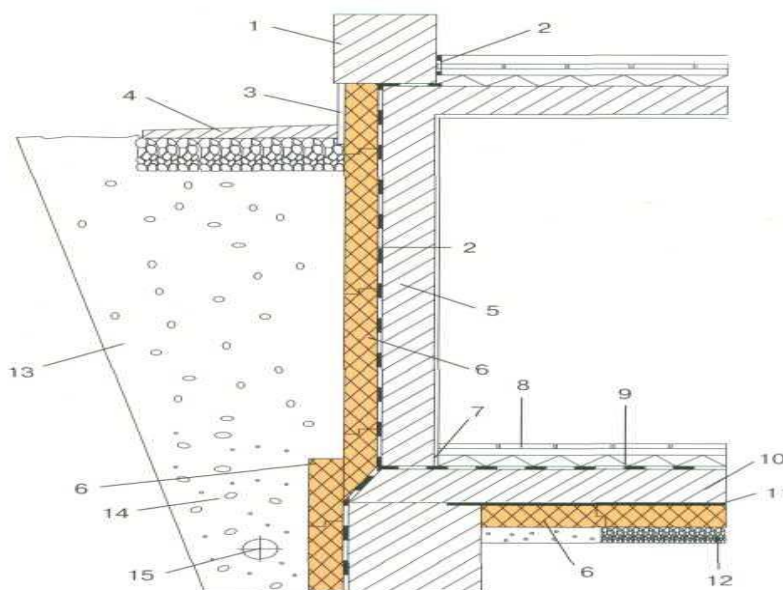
Теплоизоляция стен подвалов и фундаментов:
